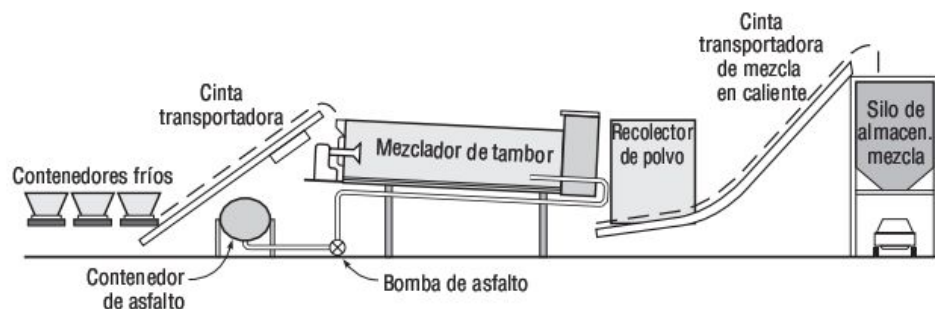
Planta continua o de tambor de hormigón asfáltico.
